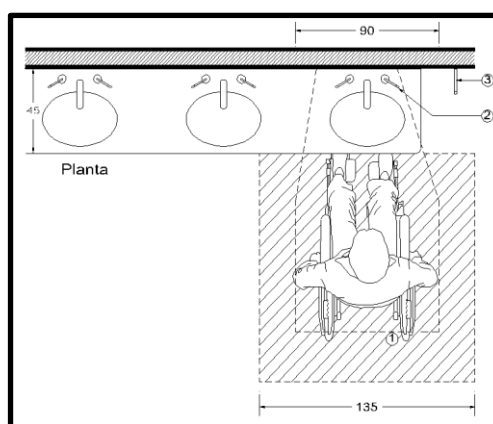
Alzado lavabo en baños, Conadis-accesibilidad, Monterrey, 2012
